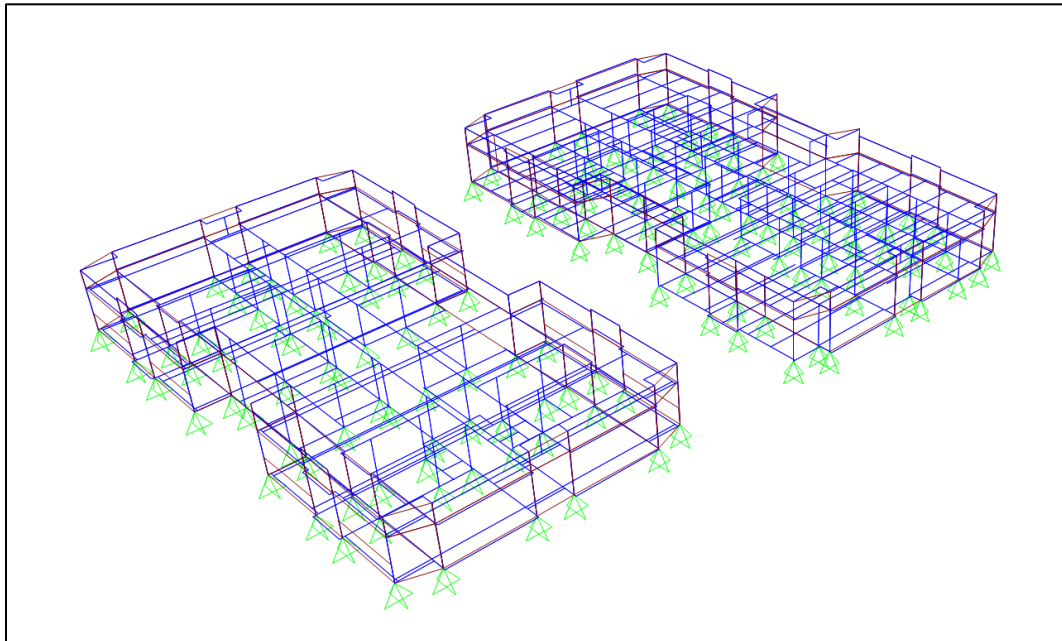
Modelo de Cálculo 2 - Estrutura de Concreto
